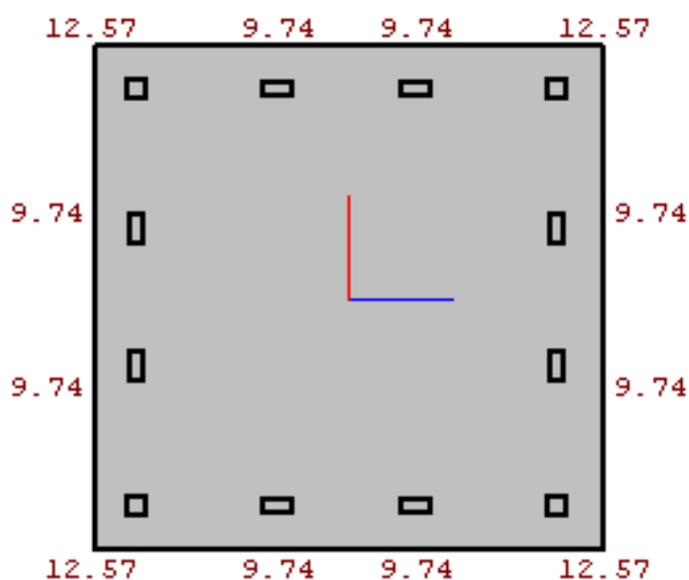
Армирование К-1.0 во втором варианте конструирования
